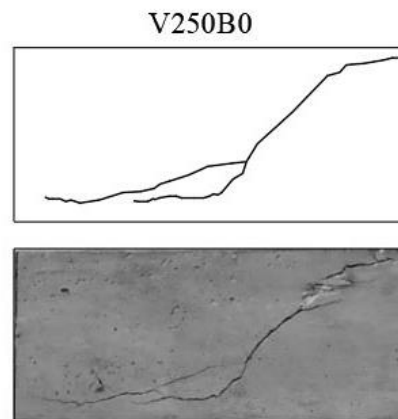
Padrão de fissuração da viga V250B0.
